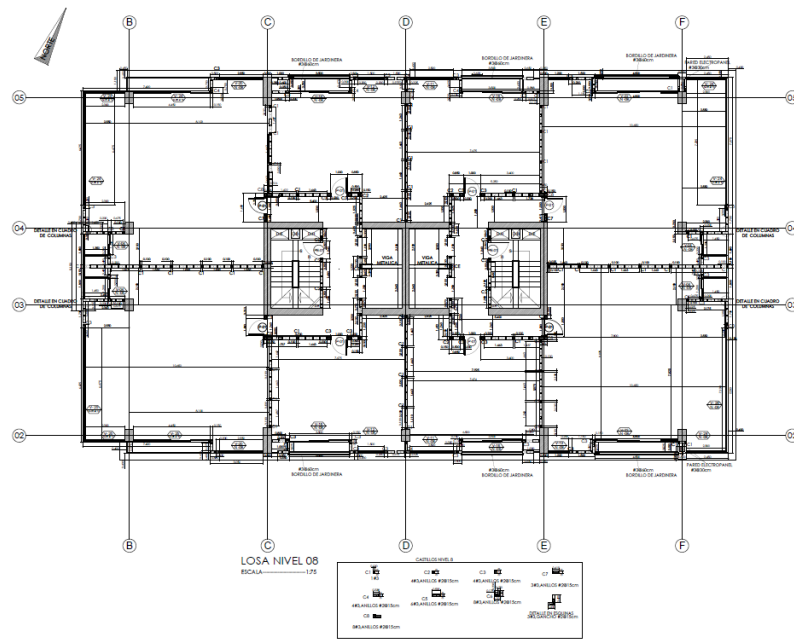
Plano de distribución de castillo losa nivel 8.
